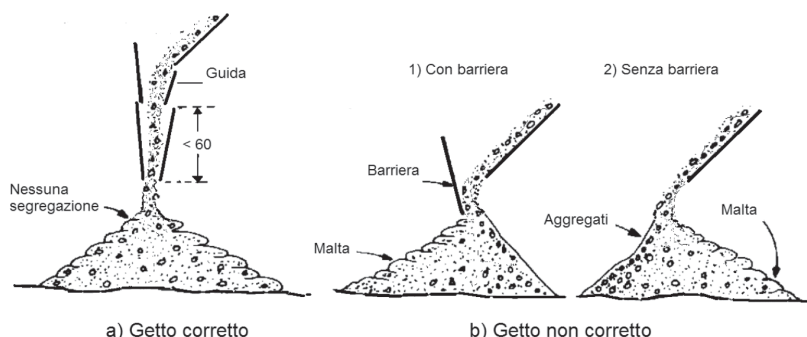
Esempi di getto di calcestruzzo da piano inclinato: a) getto corretto e b) getto non corretto. Nel caso b) si ha la separazione degli aggregati dalla malta cementizia. La barriera comporta soltanto il cambiamento di direzione della segregazione
